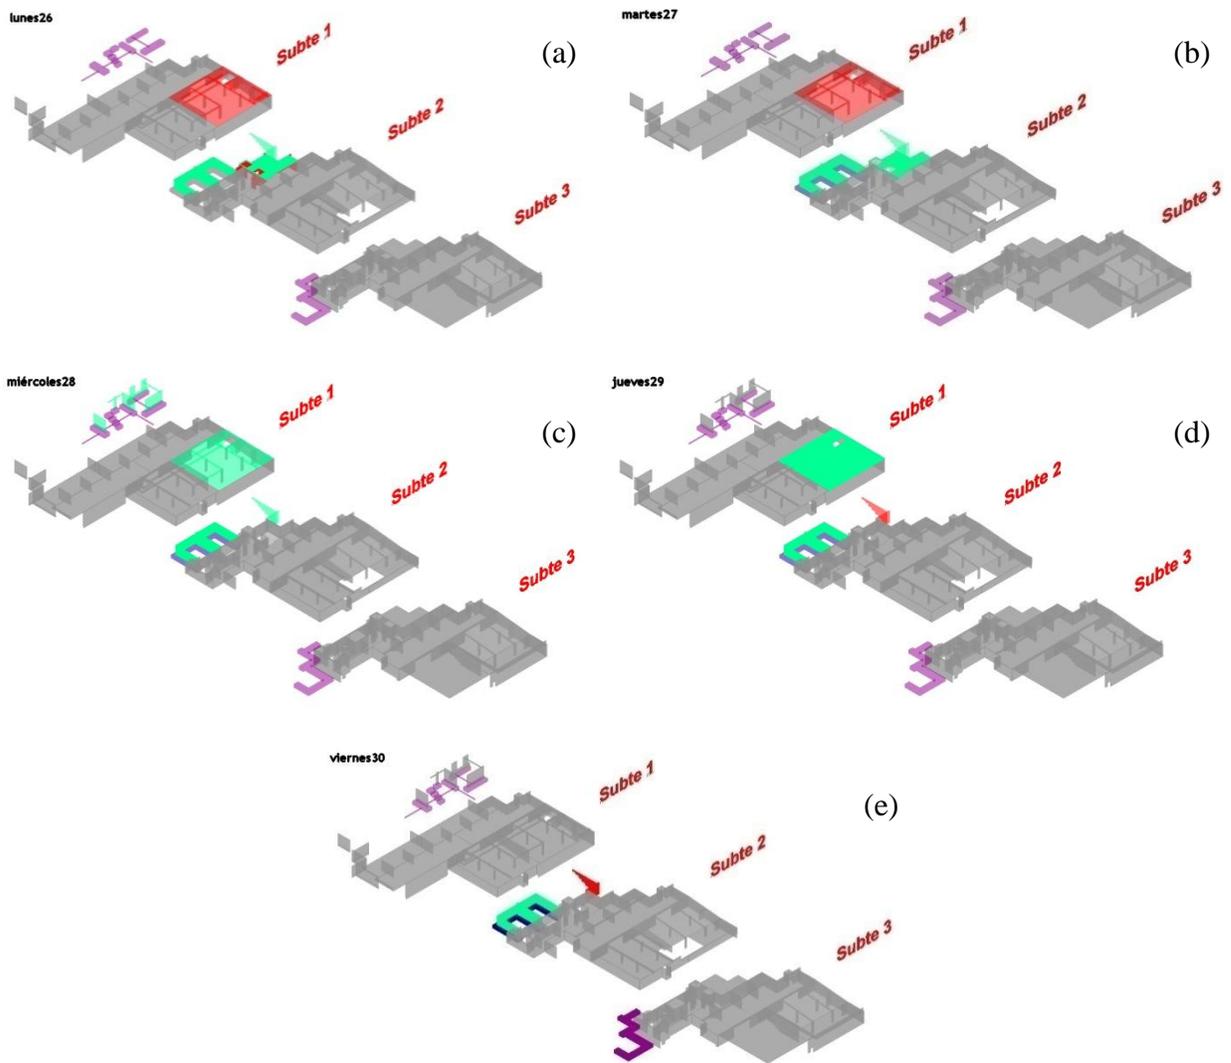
Imagen del plan de trabajo semanal mostrada durante la reunión.
